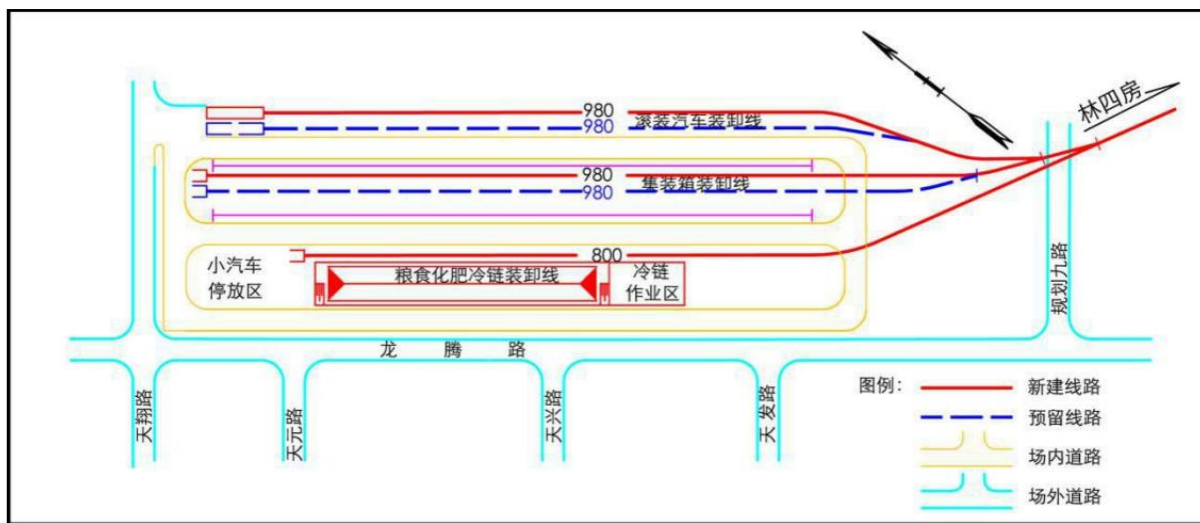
集装箱装卸区设置于场址中部装卸场平面布置示意图
